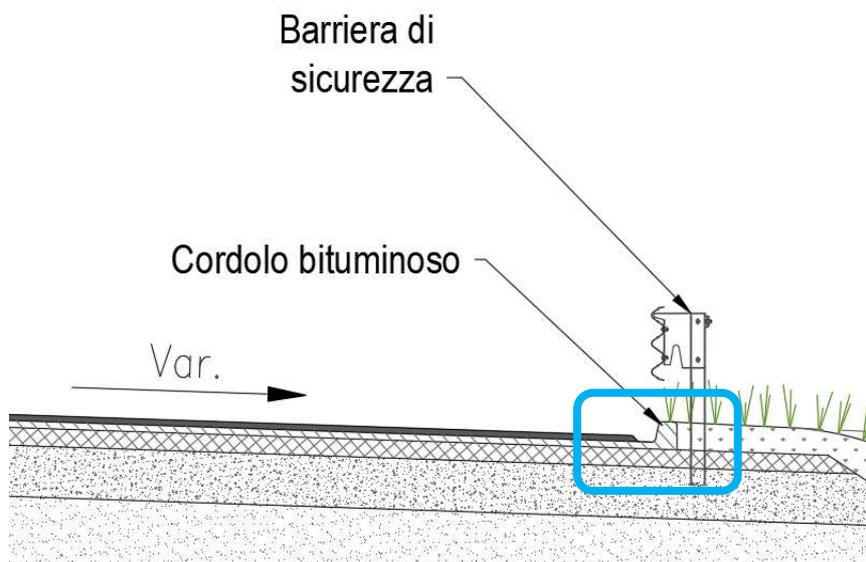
Sezione tipo con cunetta laterale ricavata nella pavimentazione stradale
